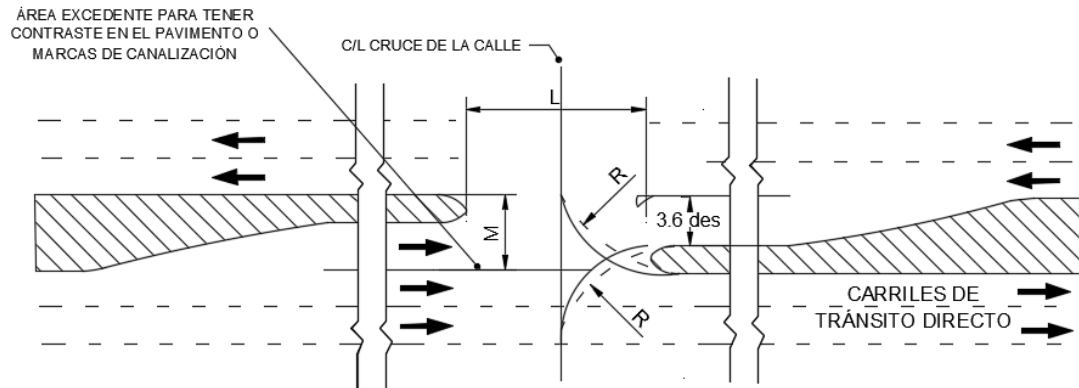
Diseños de carril para vuelta izquierda con una apertura en la faja separadora central de 4.8 a 5.4 m
